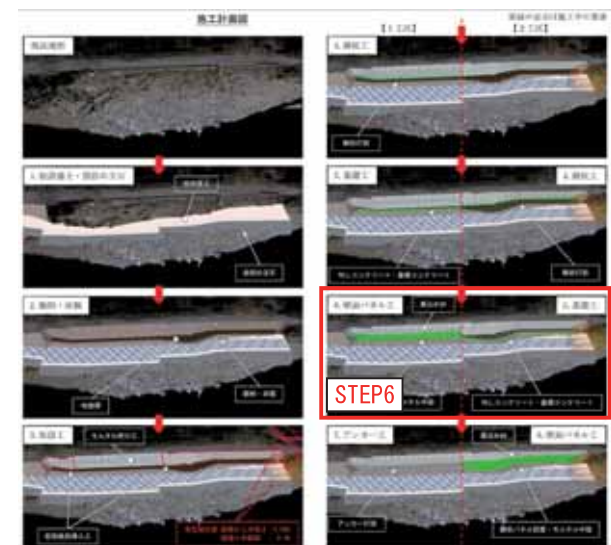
施工計画図への活用(一部抜粋：現況地形, STEP1～7)
